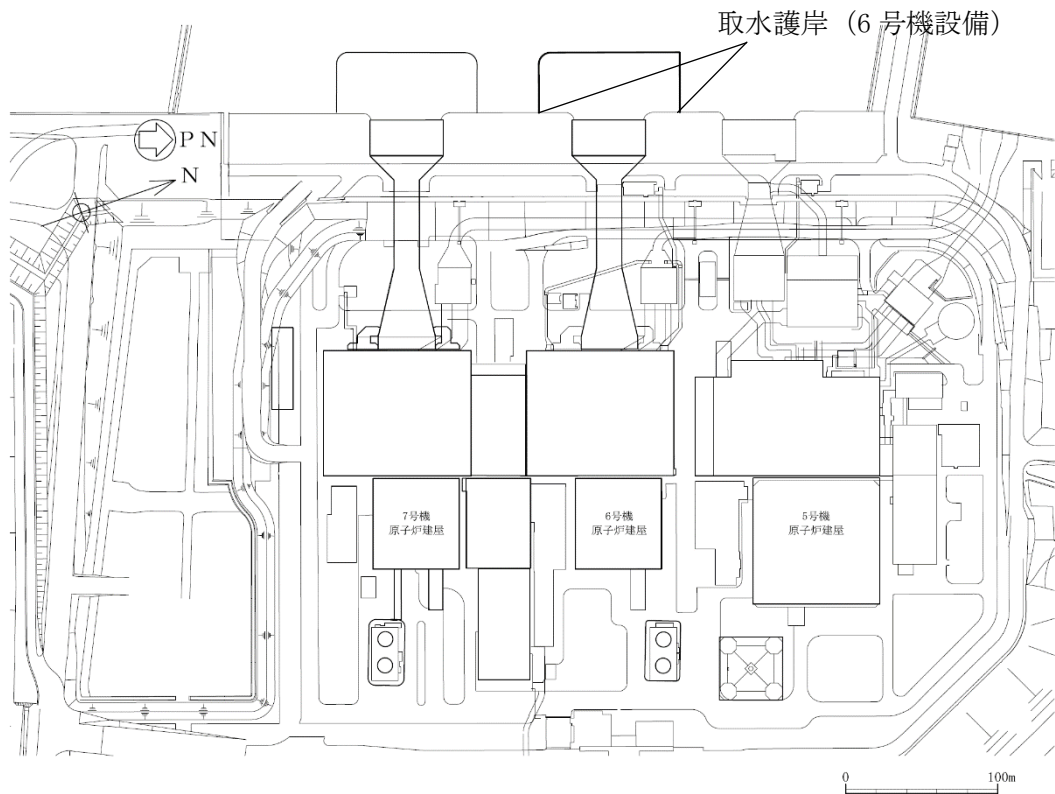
(1) 取水護岸（6号機設備）の位置図（全体平面図）
